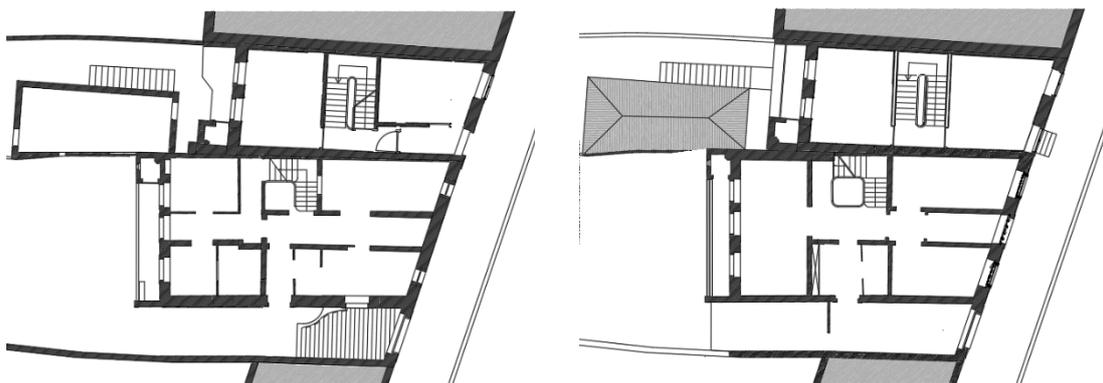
Plantas originais RC e piso 1 nº 430 e cave semienterrada e RC nº 432. Fonte: César Machado
